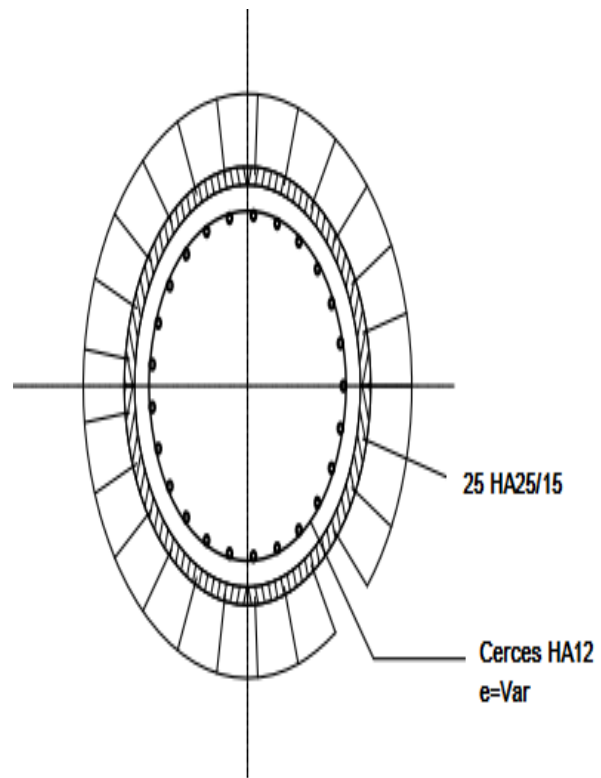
Coupe 1 sur le plan de ferrailage du PIEU
